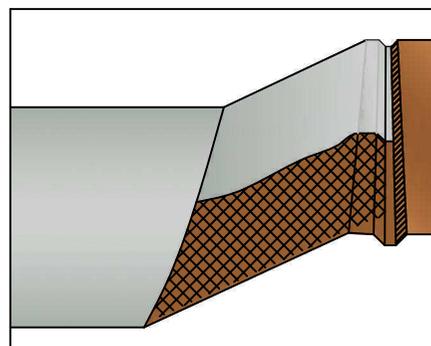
Укладка модуля георешетки "АРМОГРИД"
